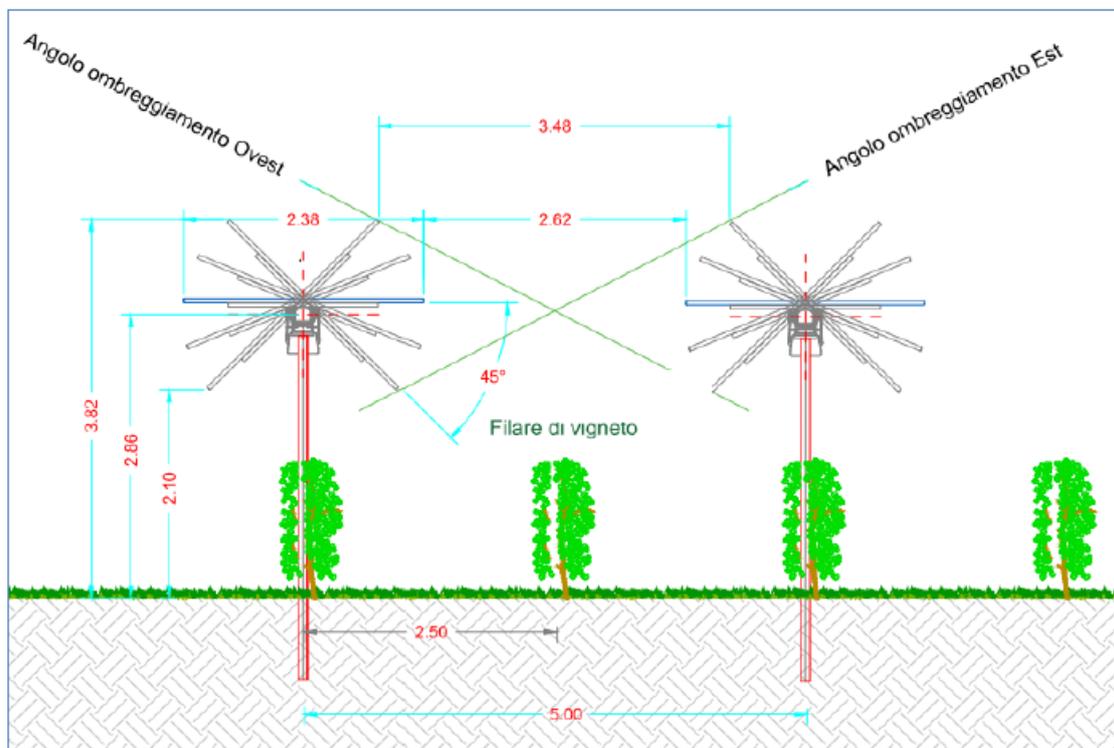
Sezione trasversale tipologica struttura Tracker con vigneto
